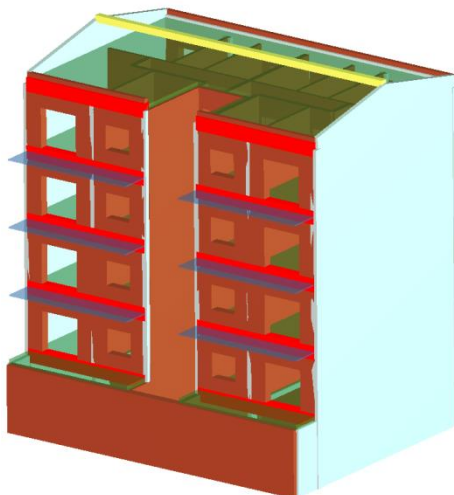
Esquema representativo da introdução do reforço de CFRP, nas vigas da fachada principal
